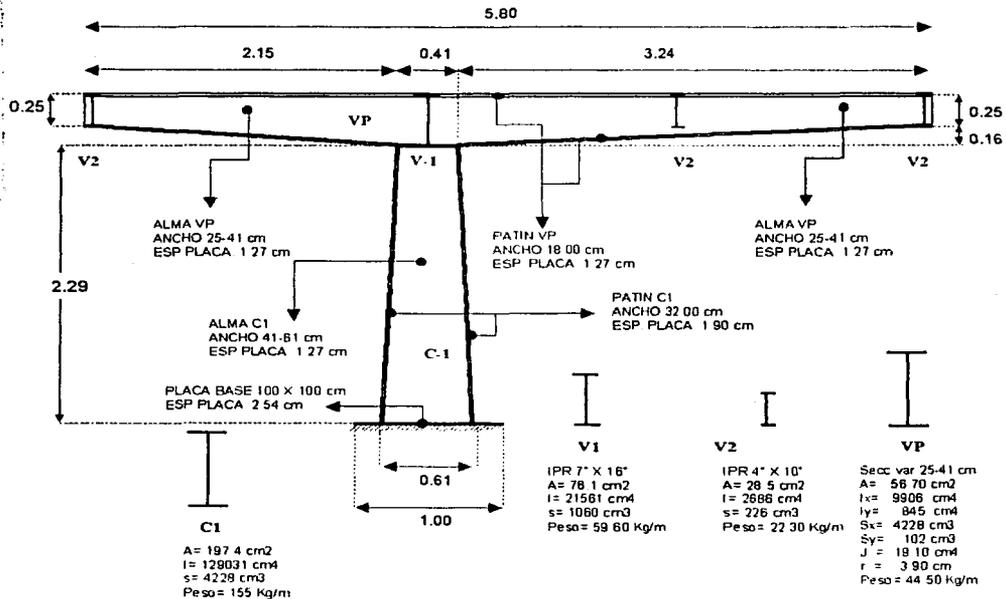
Detalle de Columnas y Vigas Metálicas
